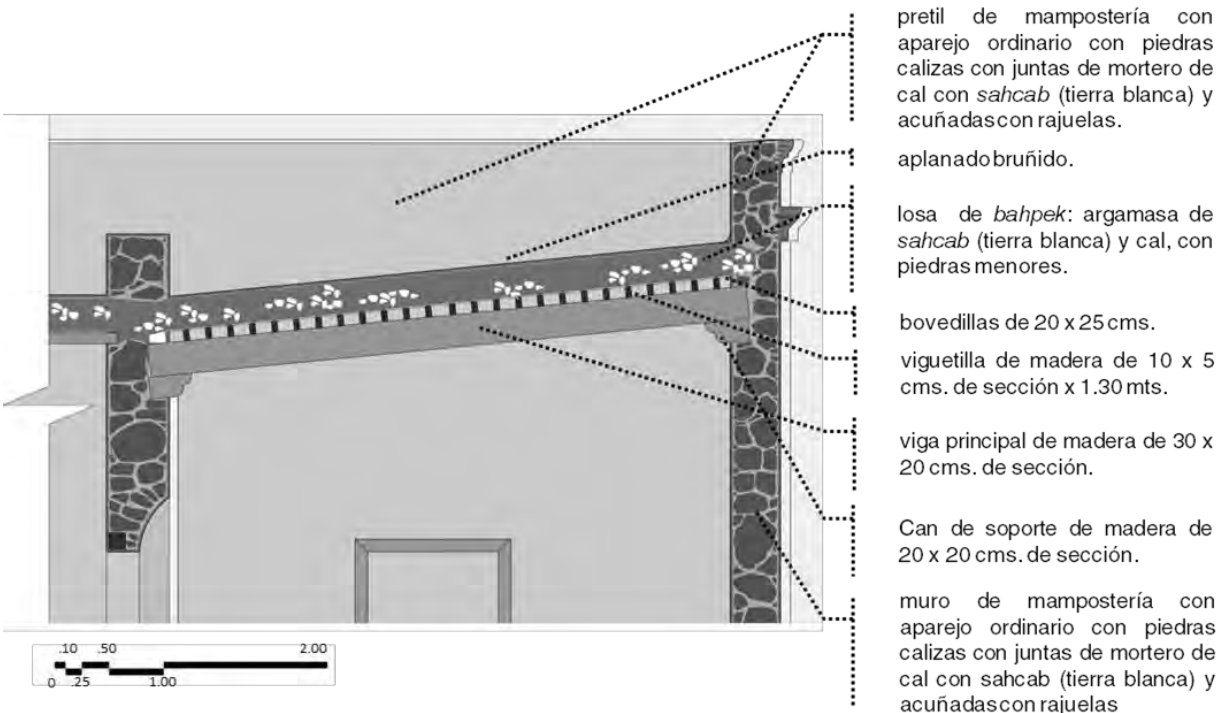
Corte por fachada de un techo solucionado con vigas y viguetillas de madera. Este sistema es el más sofisticado y su uso era para los espacios más importantes de la vivienda. Fuente: hipótesis y croquis del autor, en base a levantamiento arquitectónico en el inmueble 093, 2012.
